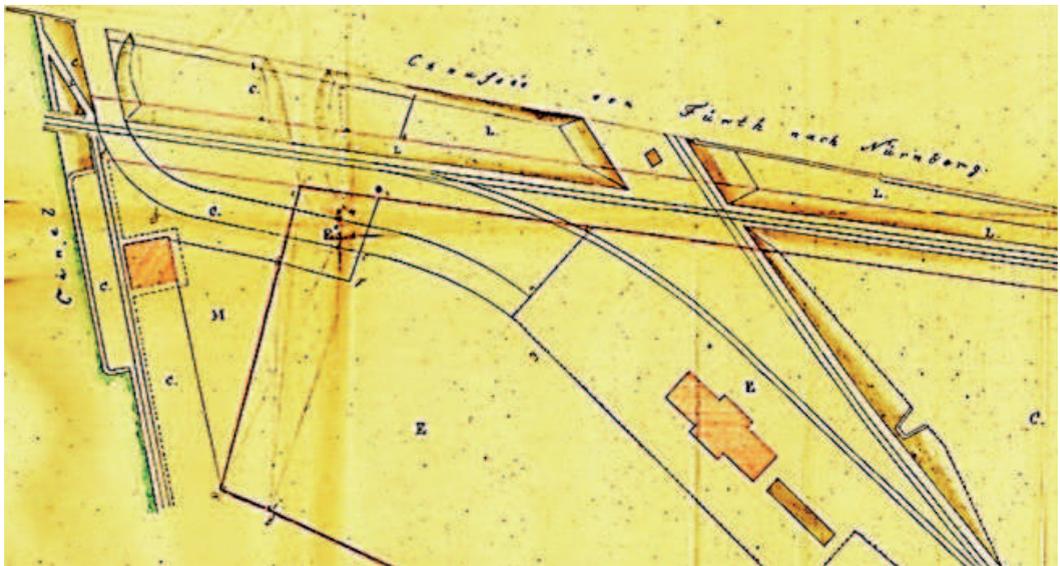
Grundriss der „Fürther Kreuzung“ mit Verbindungsgleis, Stationsgebäude und „Schupfe“ (re.) sowie Ludwigskanal mit Schleusenwärterhaus (li), oben Staatsstraße („Chaussee“) von Nürnberg nach Fürth
